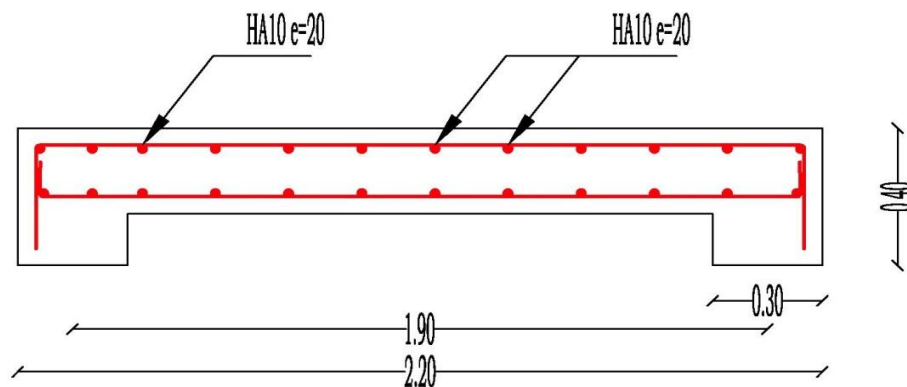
Ferrailage de la dalle machine sens L_x
